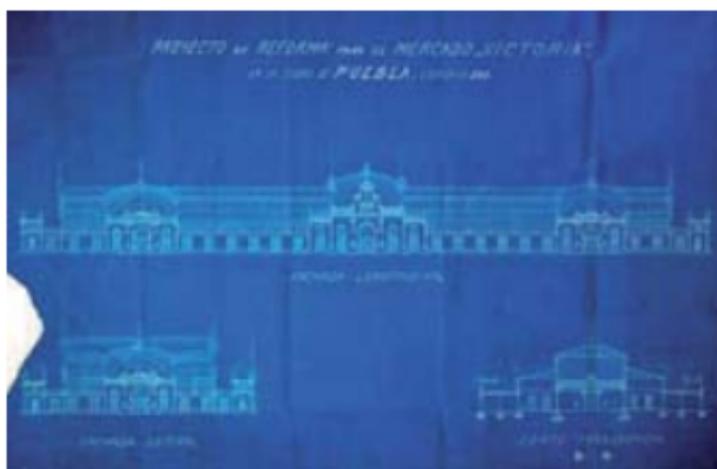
Proyecto del mercado de La Victoria en Puebla, no realizado. AHDF, Planoteca; Planero 3;
